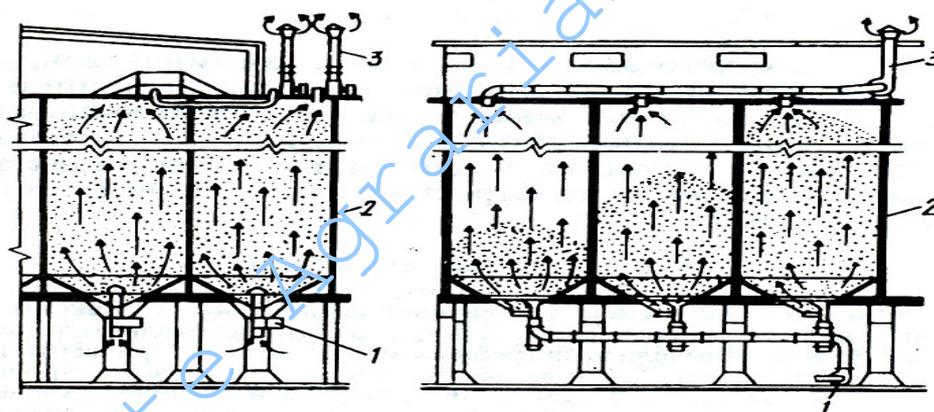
Схема напорно-вытяжной установки для вентилирования зерна вдоль силоса:
